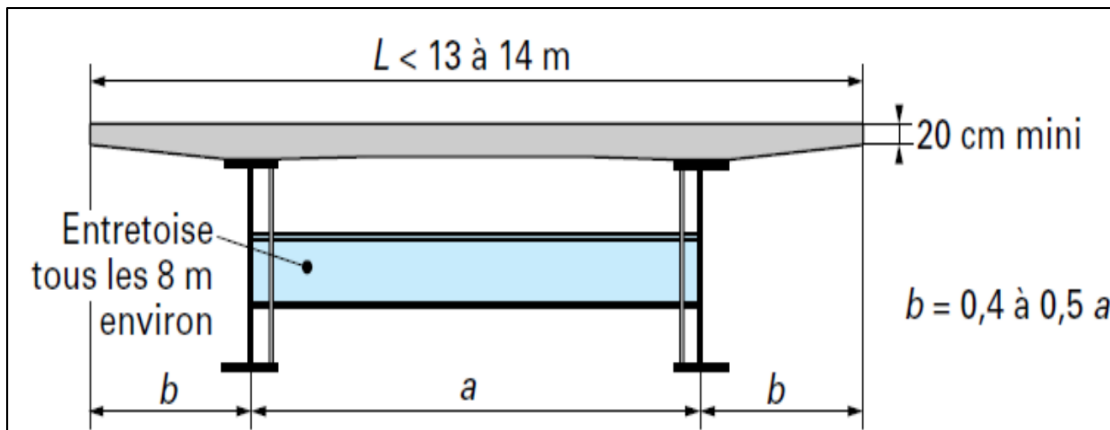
Schéma d'un bipoutre à entretoise.
